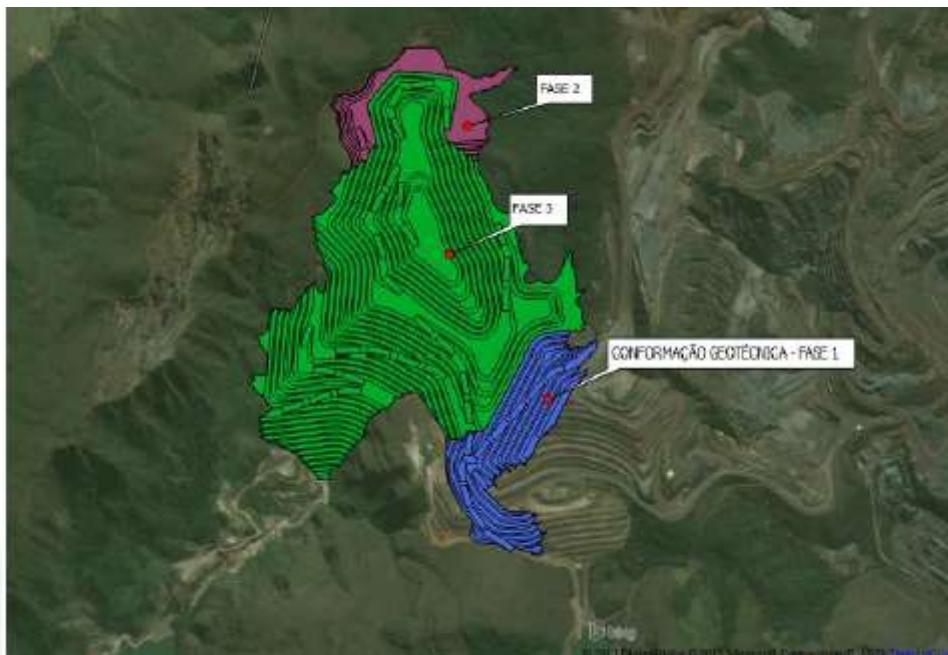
Projeto da PDE do Batateiro por fases. A Fase 1 está conformada, a Fase 2 está em operação (APO) e a Fase 3 em licenciamento. Foi subdividida em Fases IIIA e IIIB.
